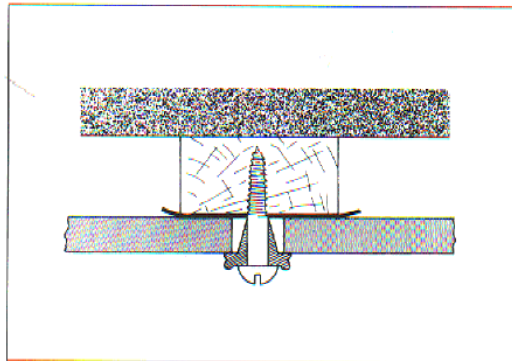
Mittelbefestigung mit HPL-Montageschrauben auf Holzunterkonstruktion mit Fugenband-Hinterlegung
